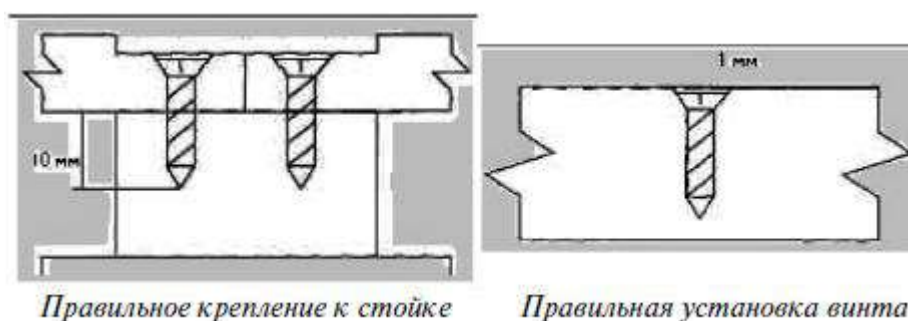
Крепление стекломагниевоы листов винтами-саморезами
